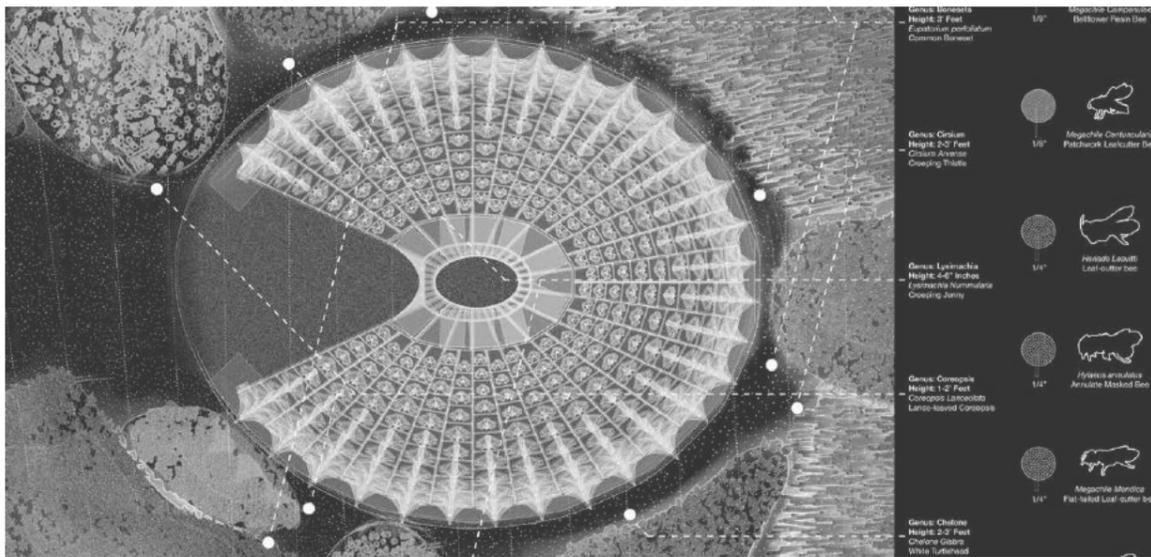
Imagen de plano de planta de Pollinators Pavillon por Harrison Satelier.
